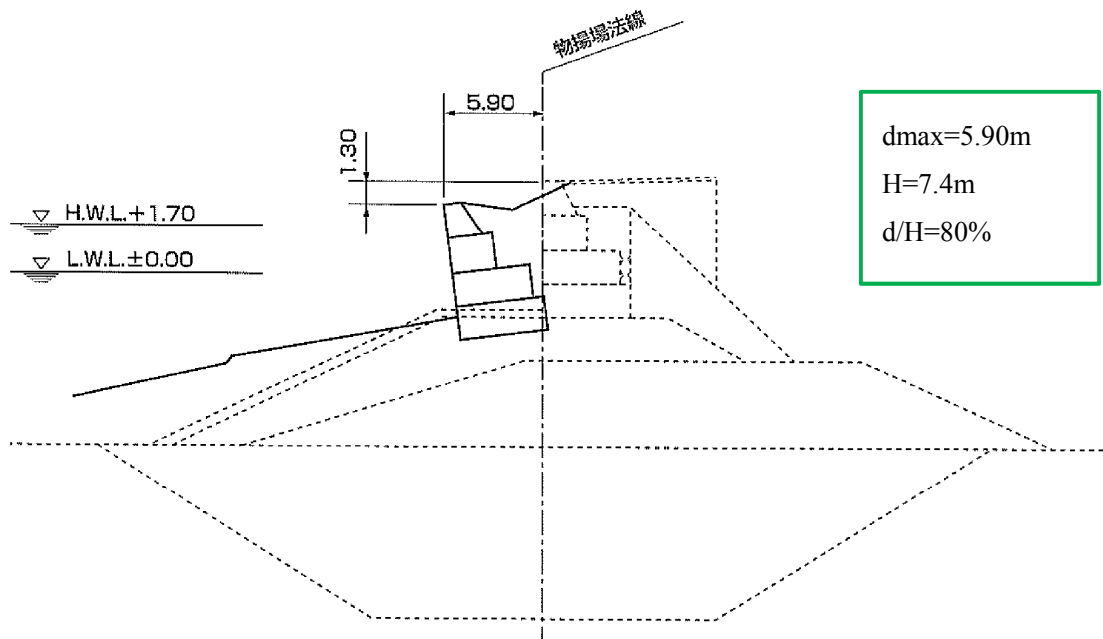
標準断面図，被災状況断面図 (A-A) (新港東、㊸旧貯木場北側物揚場)
